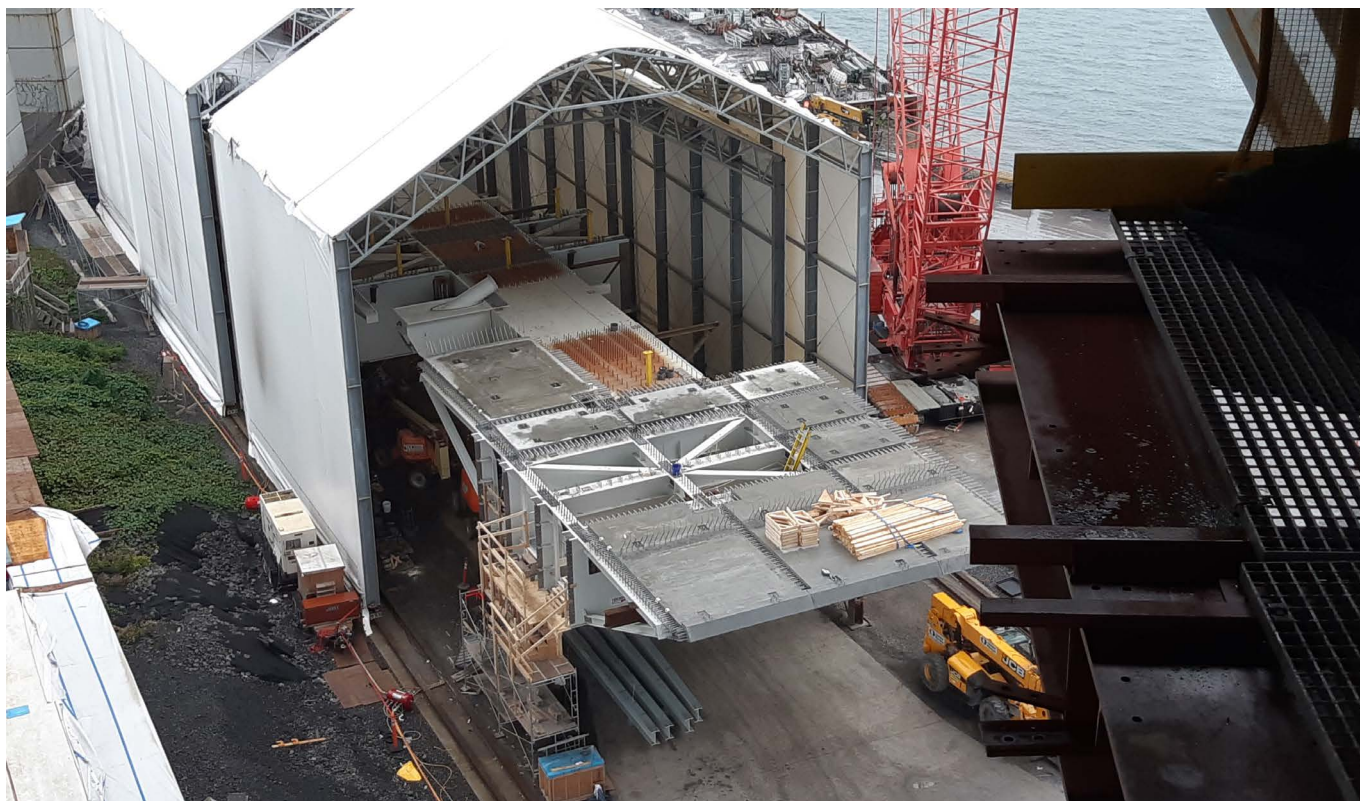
Vista de ½ dovela tipo. Puente de Champlain.
